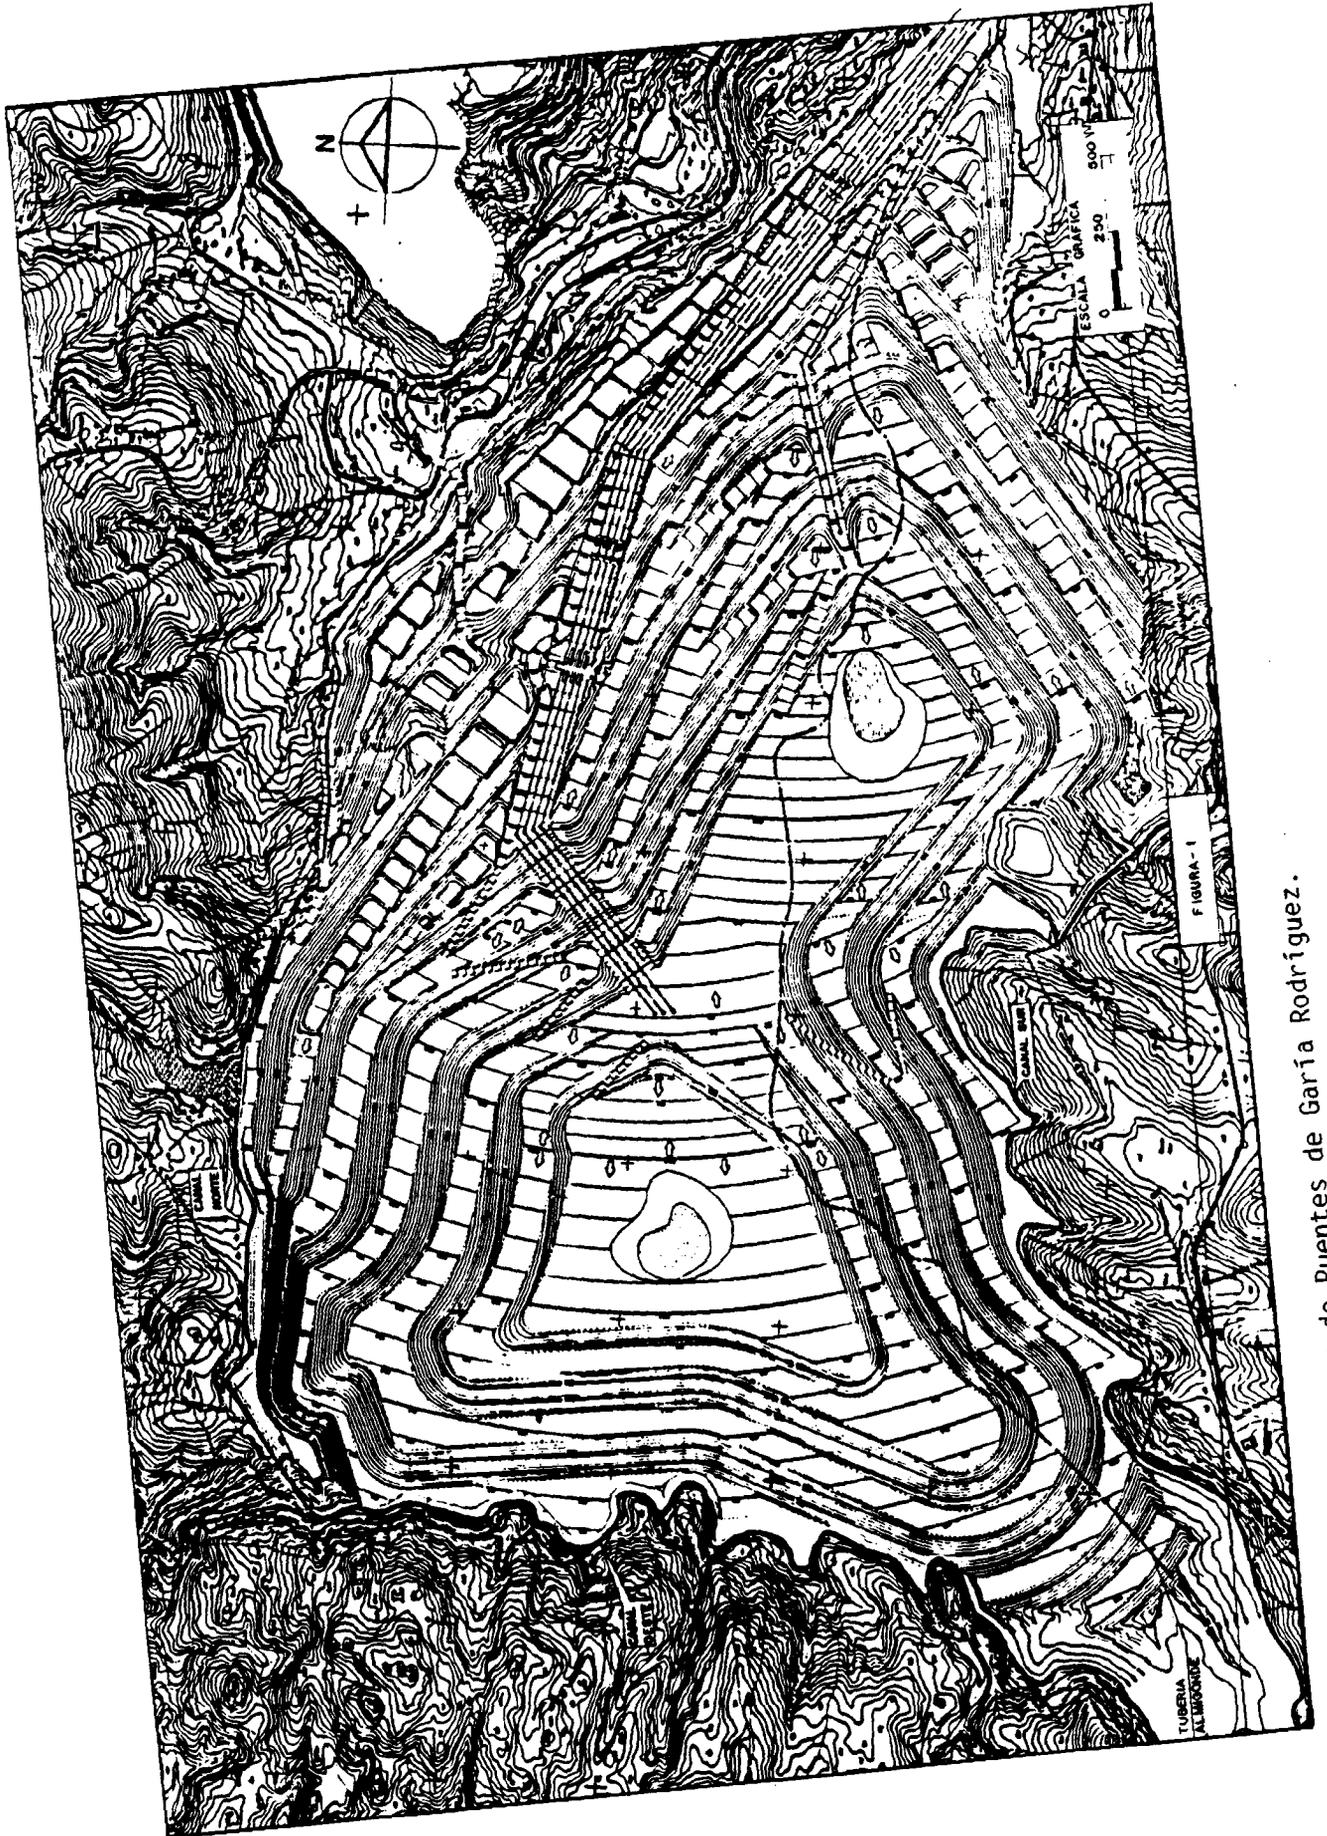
Escobrería de Puentes de Garía Rodríguez.
